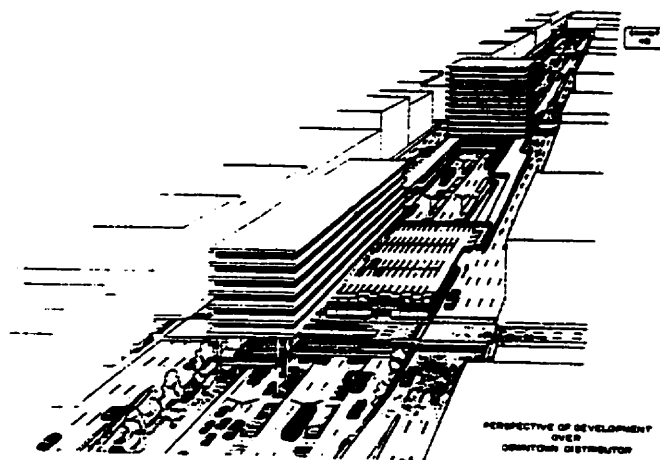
Plan routier au centre-ville d'Ottawa-Hull, tel que proposé dans le rapport OHATS.
